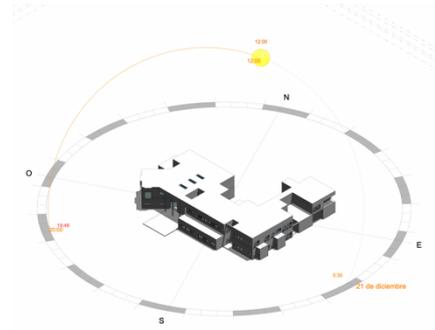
Modelo A Fuente: Elaboración propia a partir de planimetría obtenida en DOM.
